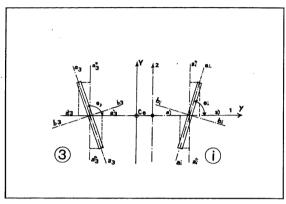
١١) يبين مسقطاً لمبنى عال ، يضم جدران أفقية ورأسية وماثلة ويتعرض لحمل أفقى مقداره (W).
